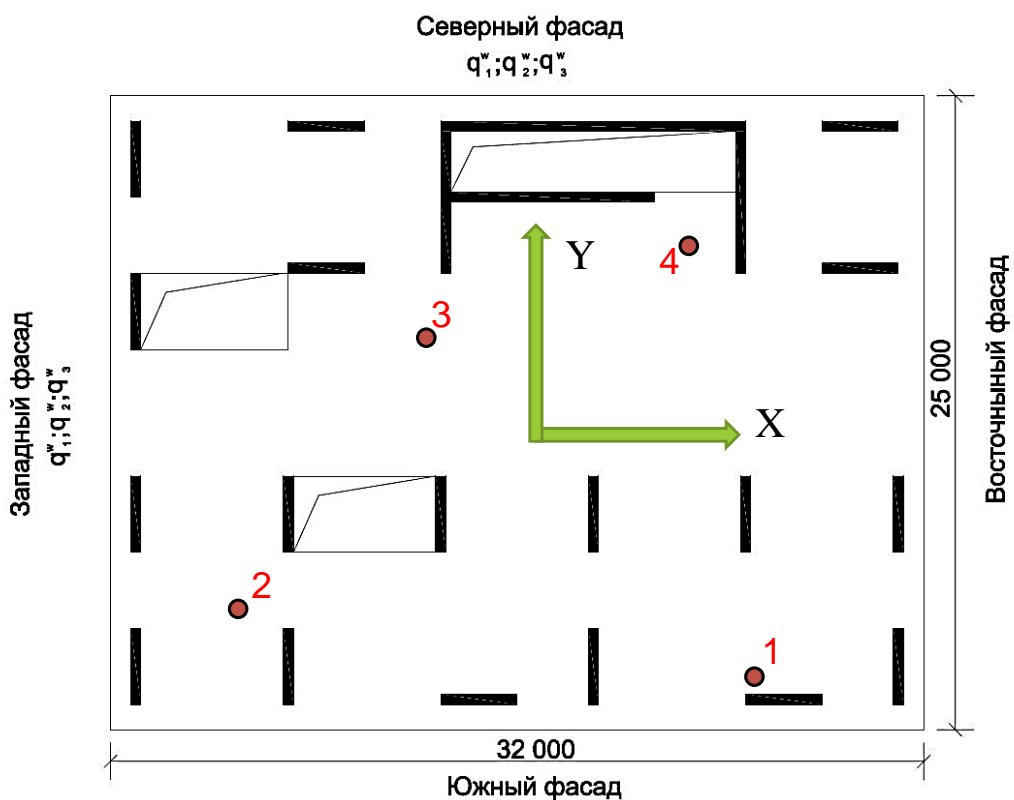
Характерные точки плит перекрытия 25-ого и 18-ого этажей
